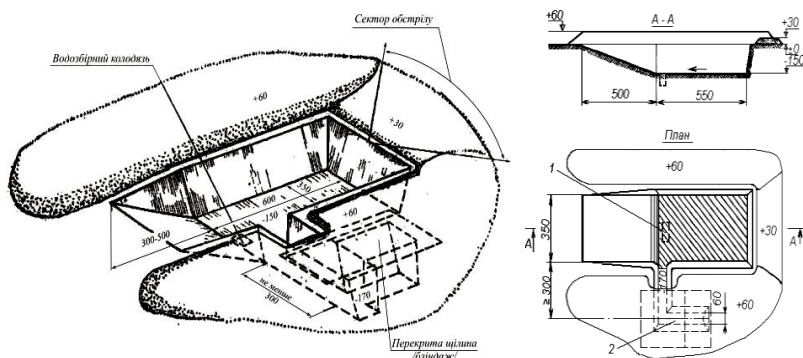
Окоп для бронетранспортера: 1 – водозбірний колодезь; 2 – бліндаж (перекрита щілина). Об'єм вийнятого ґрунту 48 м³.
